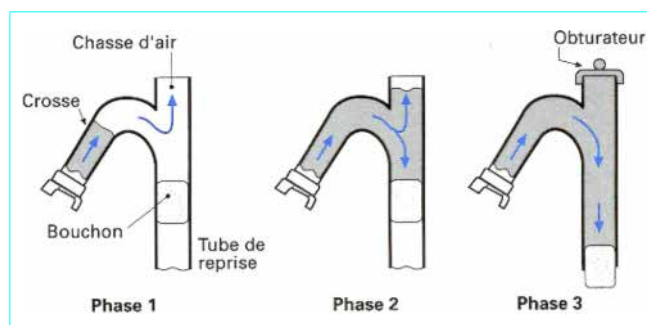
Bétonnage de pieu de fondation. Amorçage à la pompe à béton
